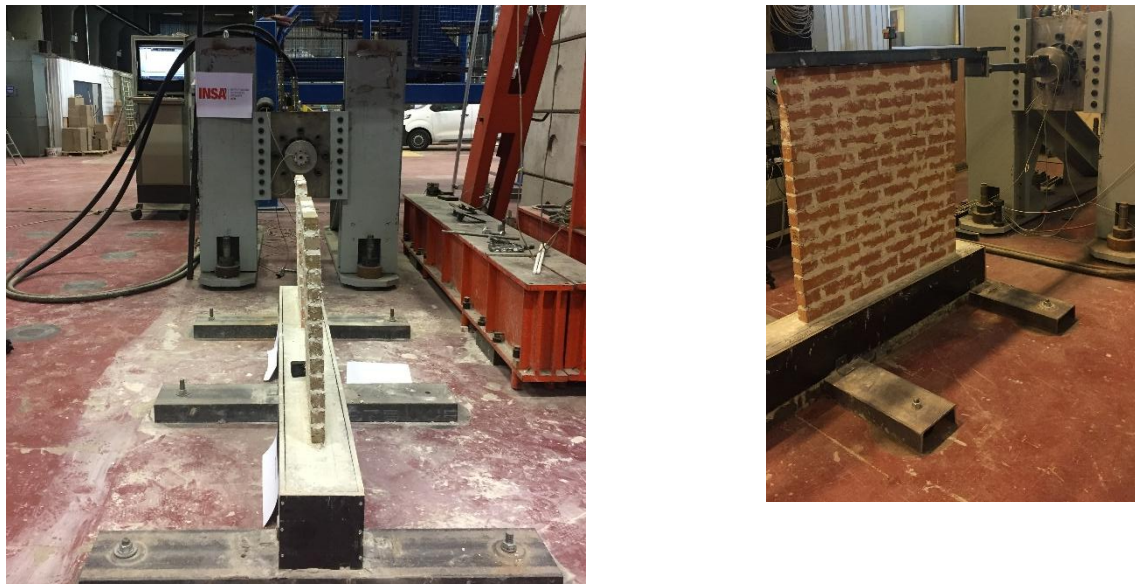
Positionnement de la poutre de fondation comportant les murs et la plaque d'appui imposant une vitesse de chargement latéral constante
